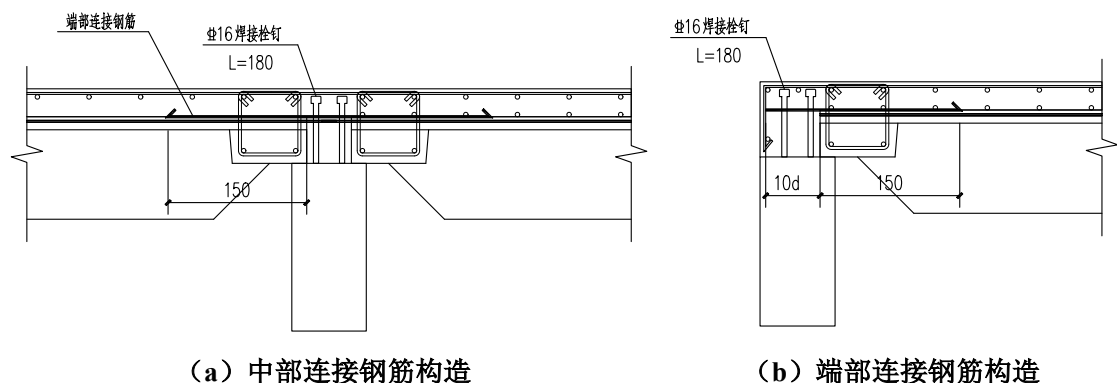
混凝土多肋叠合楼板连接钢筋构造
